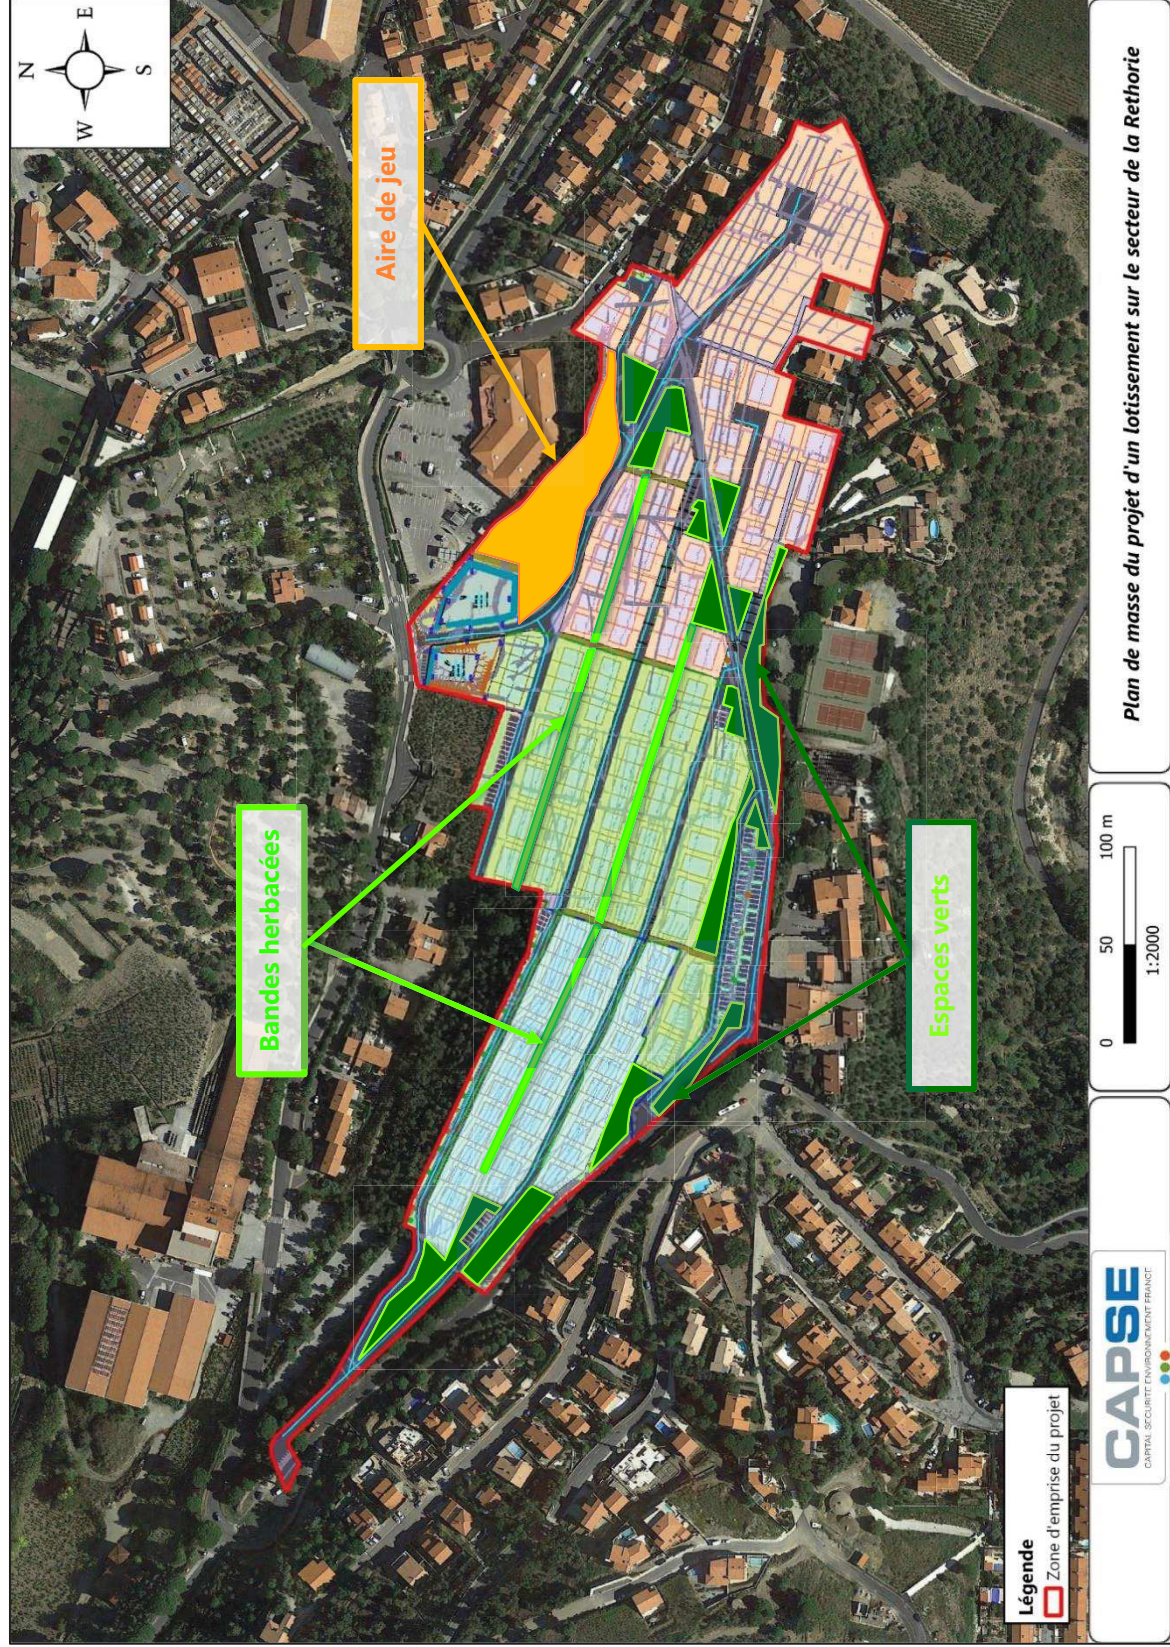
Plan de masse du projet de lotissement, avec les espaces laissés à la nature.
